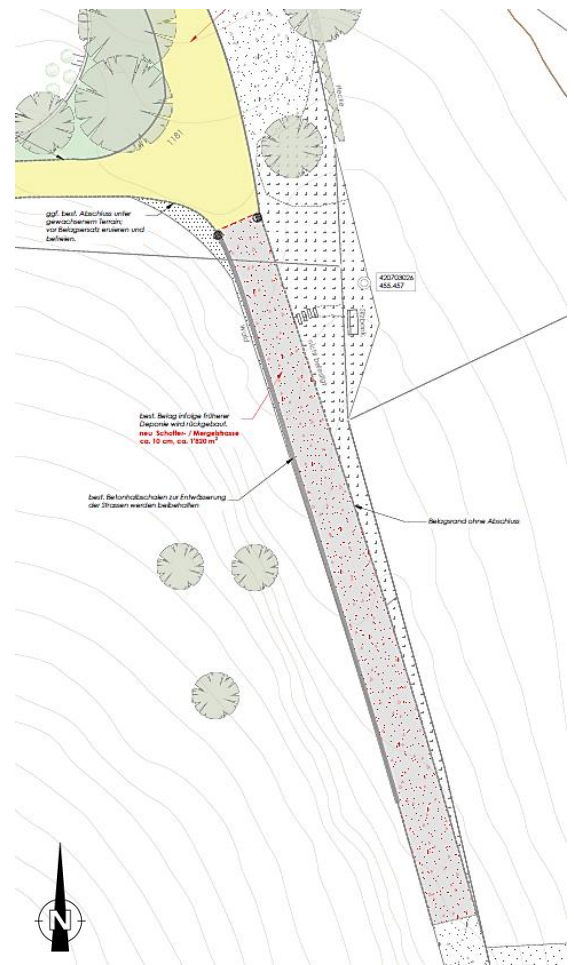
Plananschnitt Rückbau Belag auf Waldstrasse
